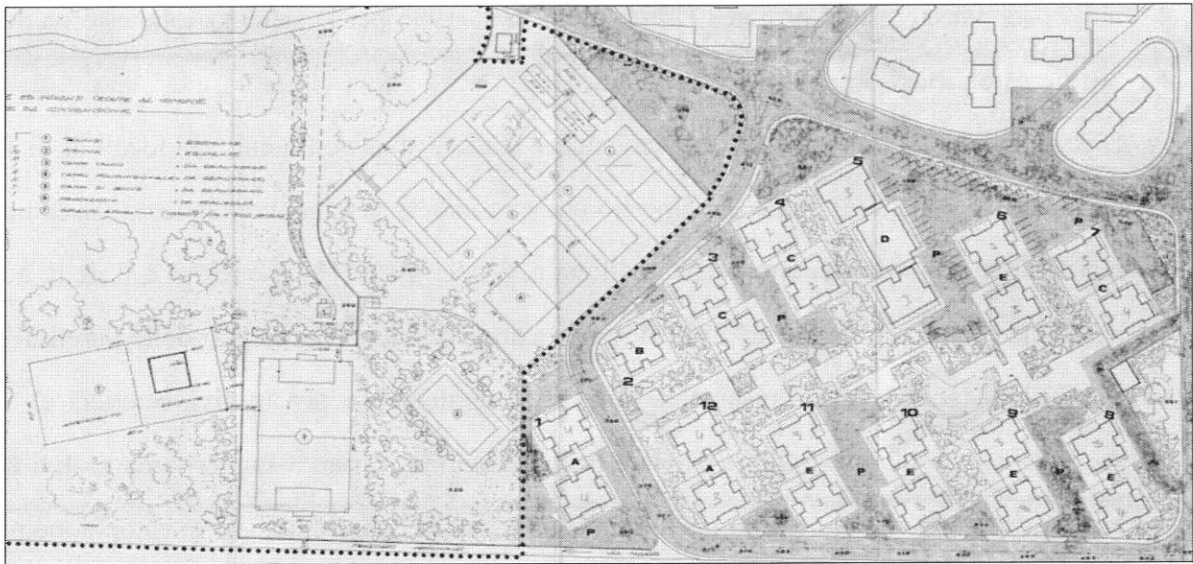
Stralcio planimetria con indicazione dei fabbricati e relativi lotti fondiari.
